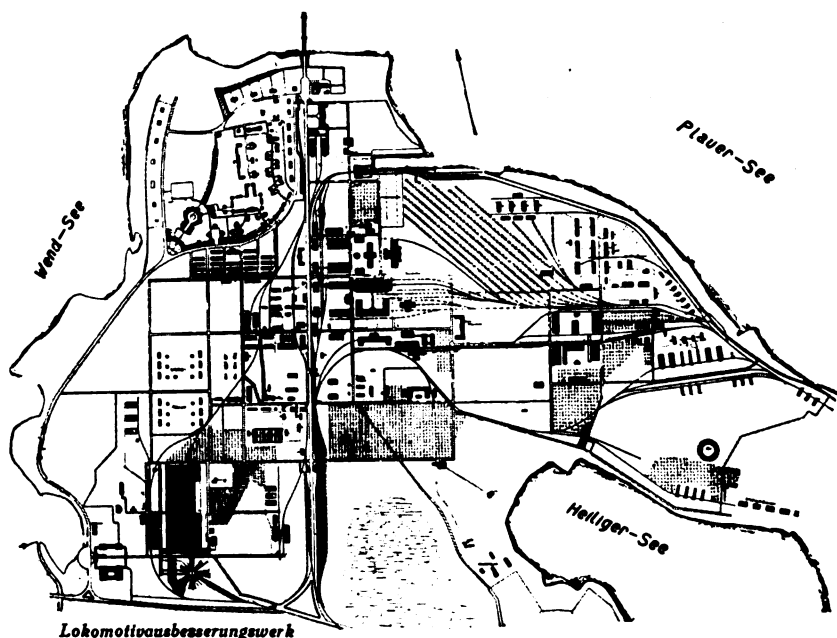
Lageplan des Eisenbahnwerkes Brandenburg-West.
